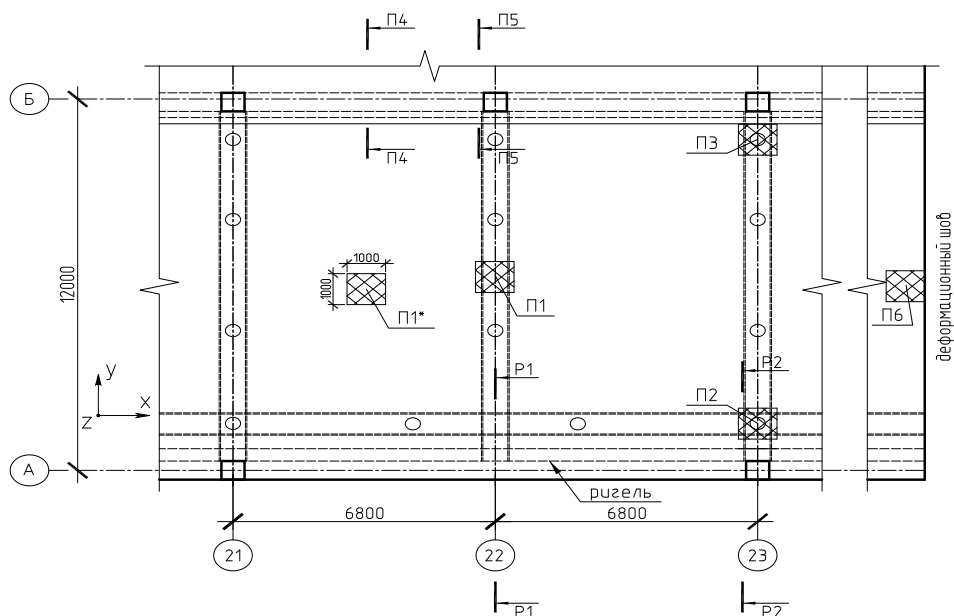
Расчетные сечения неразрезной железобетонной плиты проезжей части
